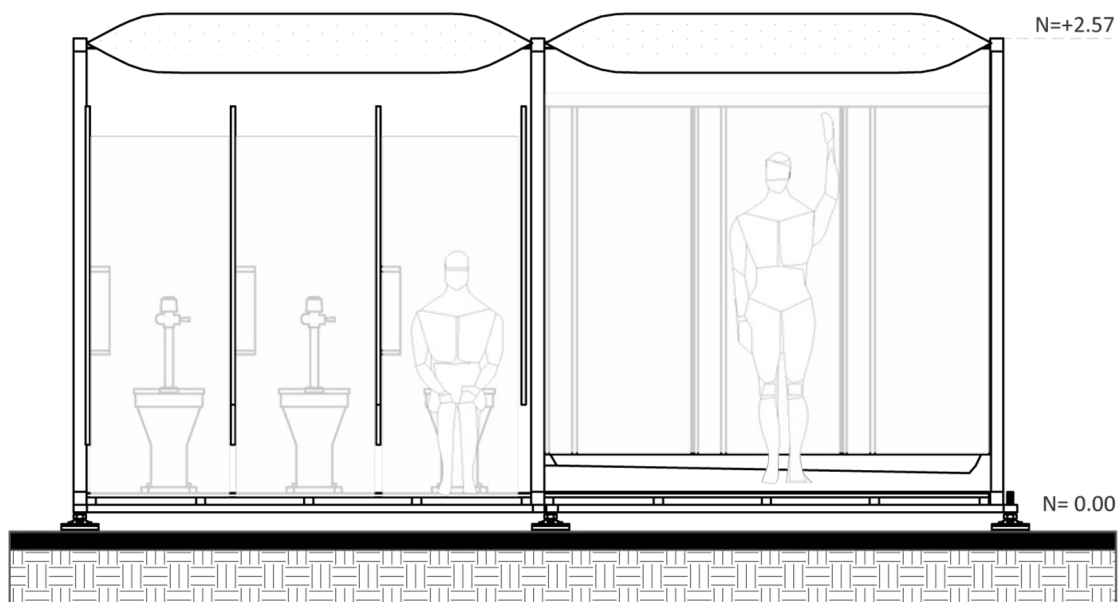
Sección A-A Zona de aseo. Elaboración: Autores. Escala 1:50
